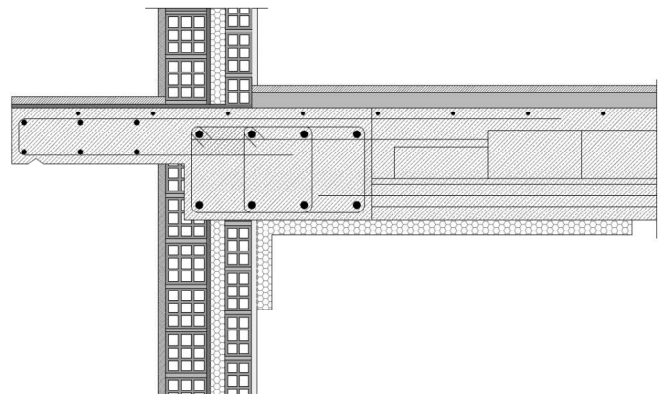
Fachada-Forjado (balcón). Zona este. Mejora.
